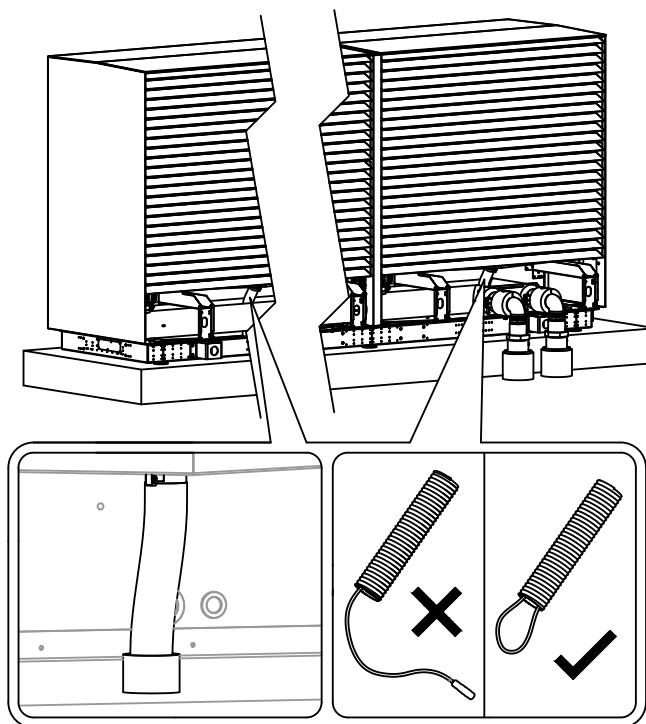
AirCalor-K K-70/-105/-140-installation du tube de purgeur de condensats dans le tuyau de drainage de la fondation.
